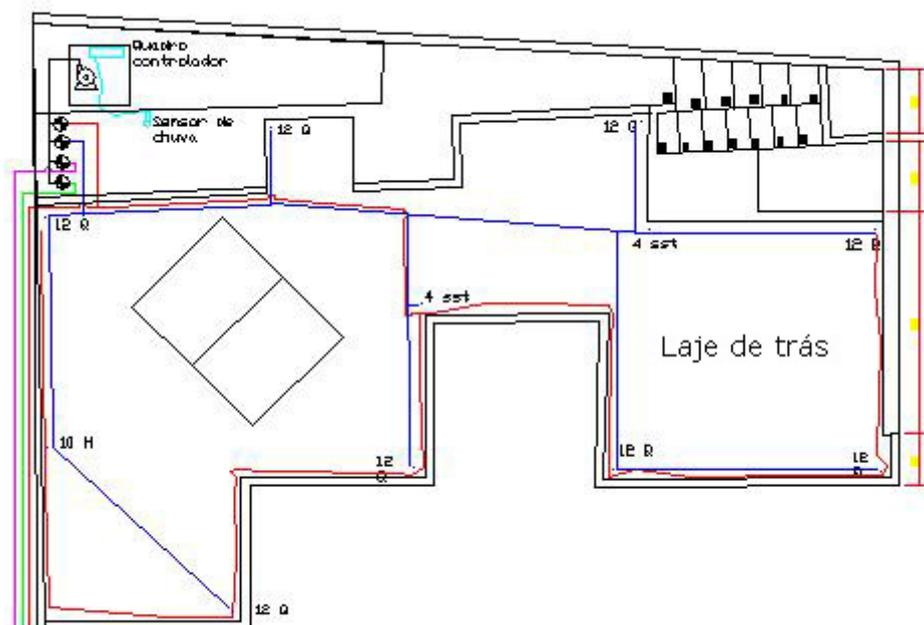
Setorização do sistema de irrigação Ecohouse Urca, em planta baixa
